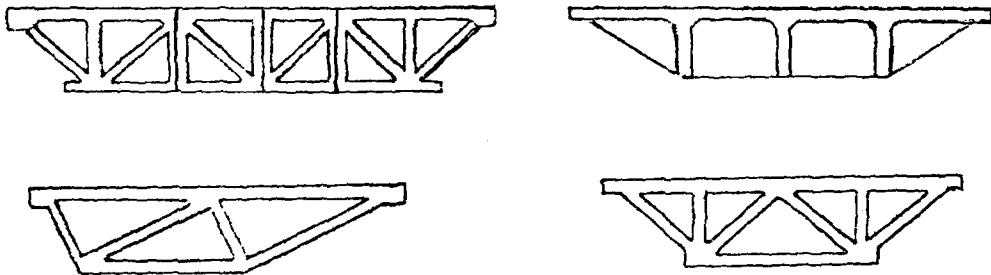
Paralel başlıklı prefabrike betonarme kafes kirişler[14].
